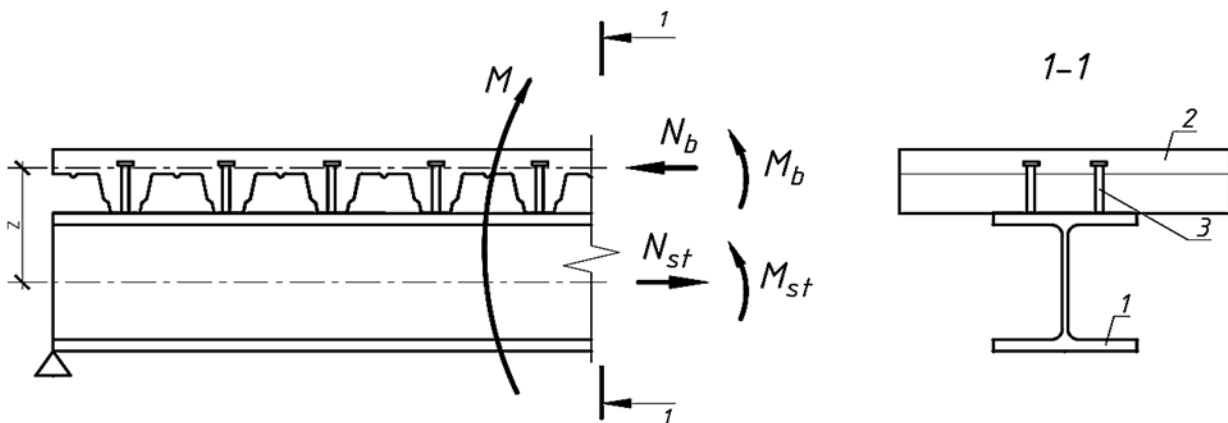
Схема розподілу зусиль у комбінованій балці при згинанні: 1 – сталевая балка; 2 – залізобетонна плита; 3 – анкерні упори. M – згинальний момент від навантаження; M_b – момент в плиті; M_{st} – момент в сталевій балці; N_b – поздовжня сила в бетоні; N_{st} – поздовжня сила в сталевій балці; z – плече пари сил.
